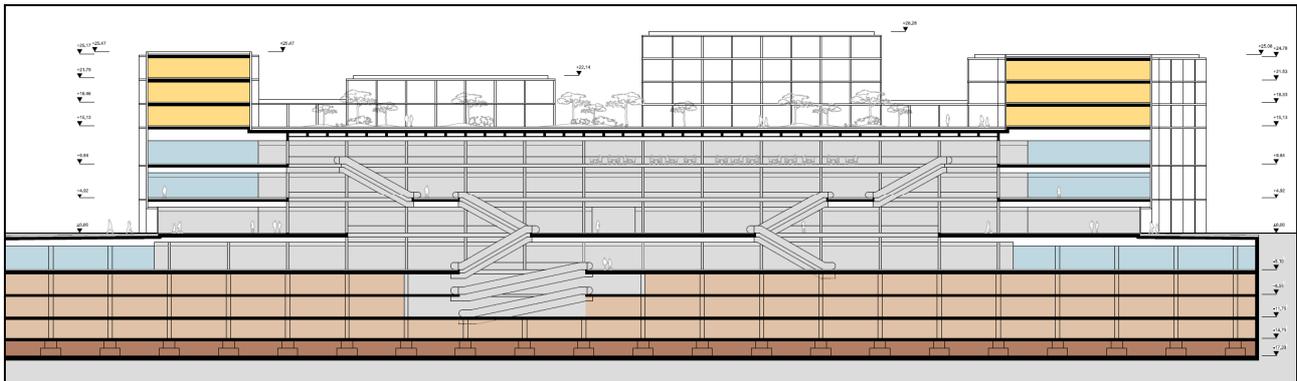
Sezione schematica dei piani interrati dell'opera in progetto
